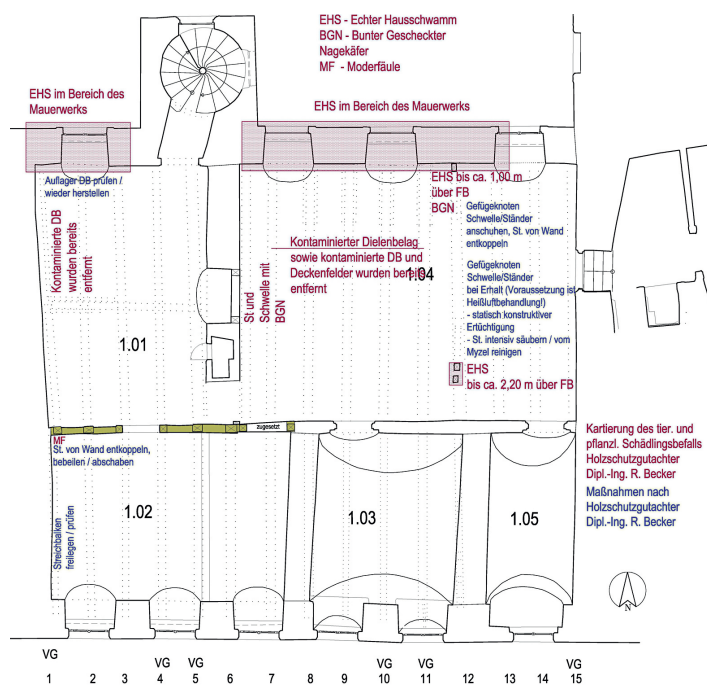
Grundriss 1. Obergeschoss mit Kartierung des Holzschutzgutachters
